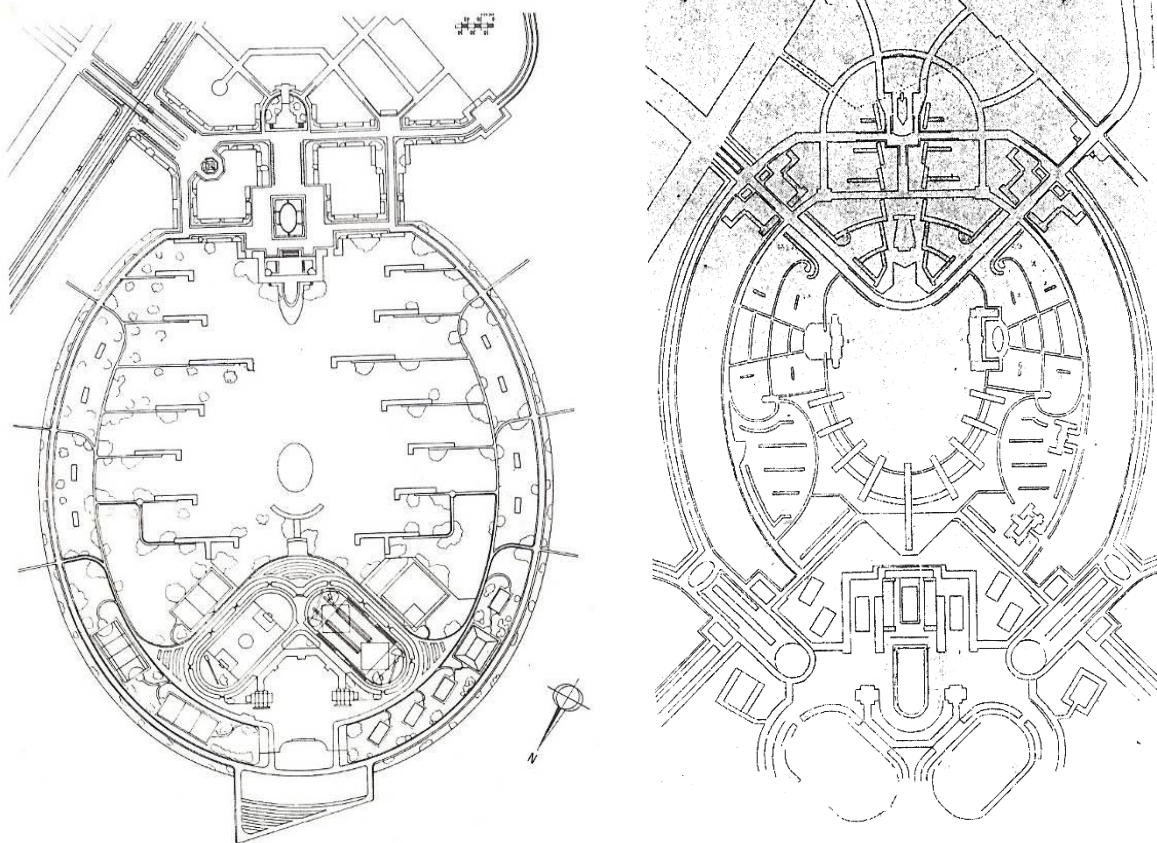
Rothers Lageplan Nr. 2 aus dem Jahr 1936. Abb. 208 Rothers Lageplan Nr. 8 aus dem Jahr 1938.
